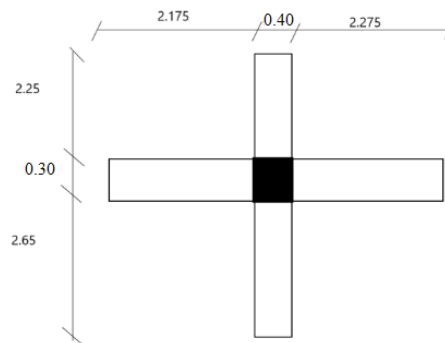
Surface afférente poteau intermédiaire (B-3)
